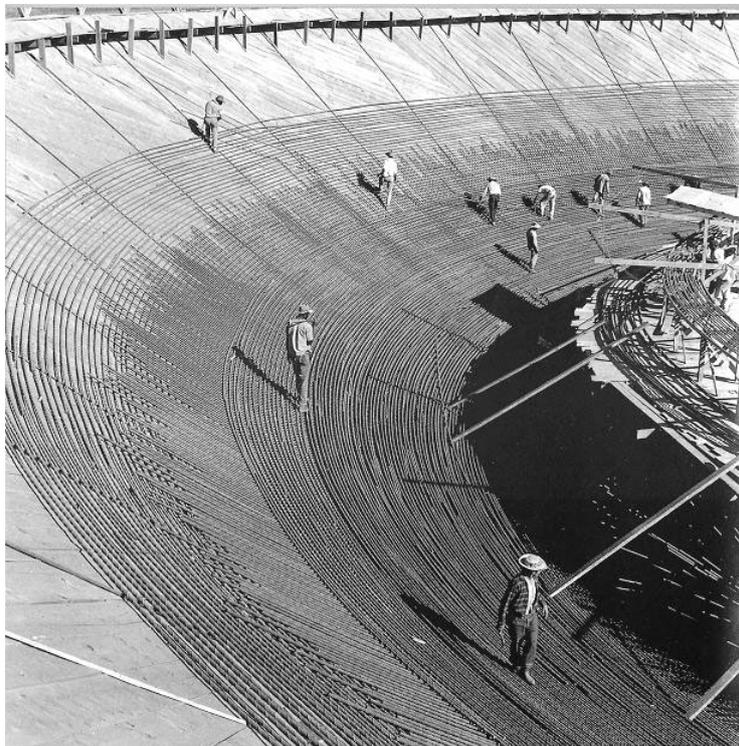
Foto da Construção da Cúpula da Câmara. Fonte: Arquivo Público do DF
